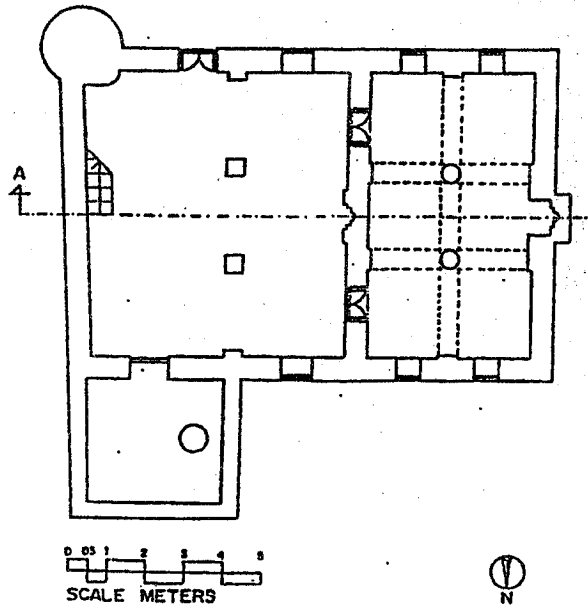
مسقط أفقي لمسجد الفوروداني بزنجبار.
